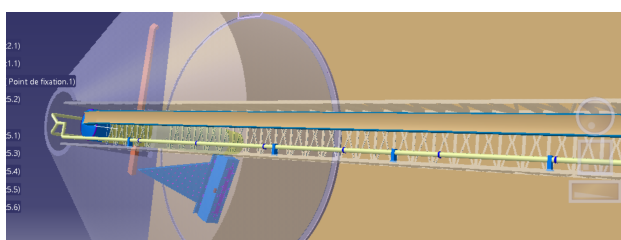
Installation 5 - Conduites parallèles aux convoyeurs
